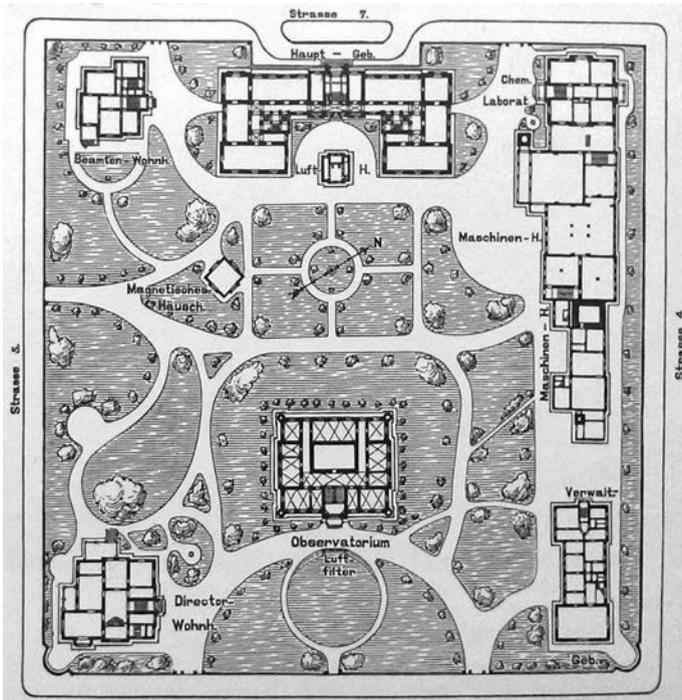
PTR, Lageplan, Architekt: Theodor Astfalck, Druck: 1896
